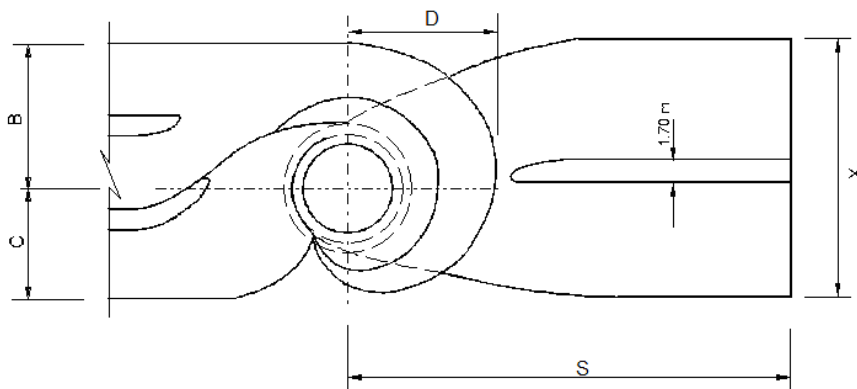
Planta de caixa semi-espiral e tubo de sucção – Turbina Kaplan com caixa semi-espiral de concreto.
